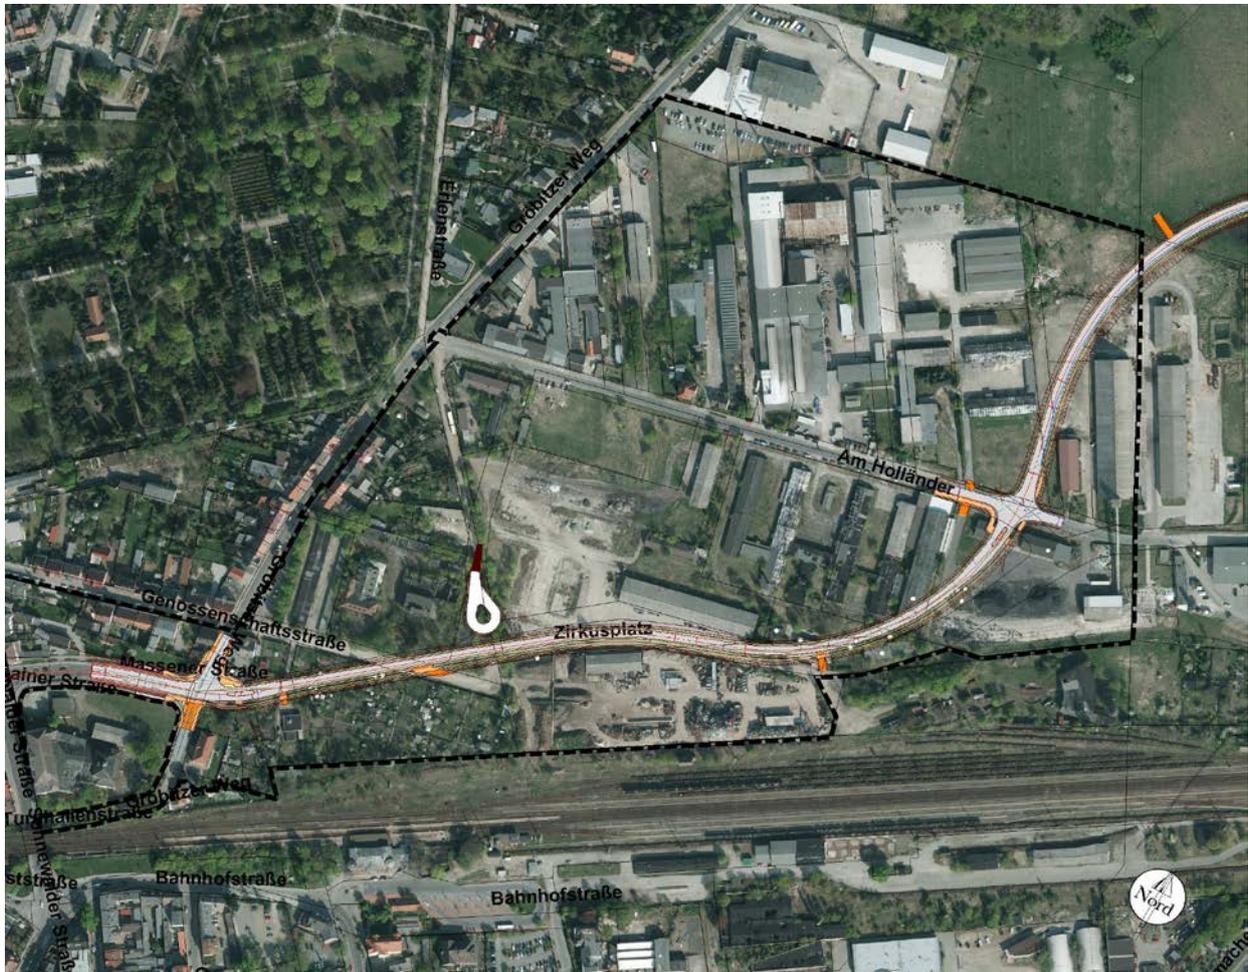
Übersichtsplan Luftbild mit planfestgestellter B 96
